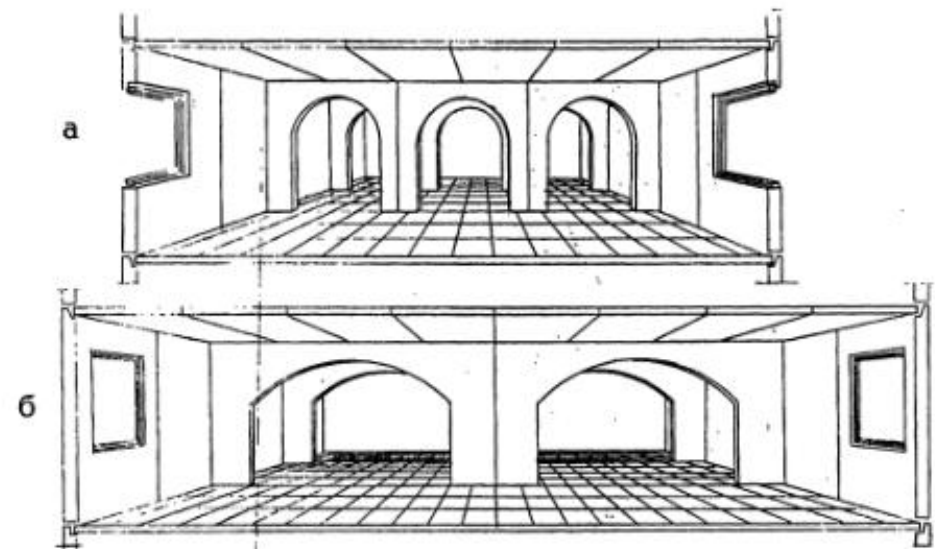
Примеры интерьеров залных помещений с промежуточными опорами из спаренных про- стенок арочных панелей внутренних стен
